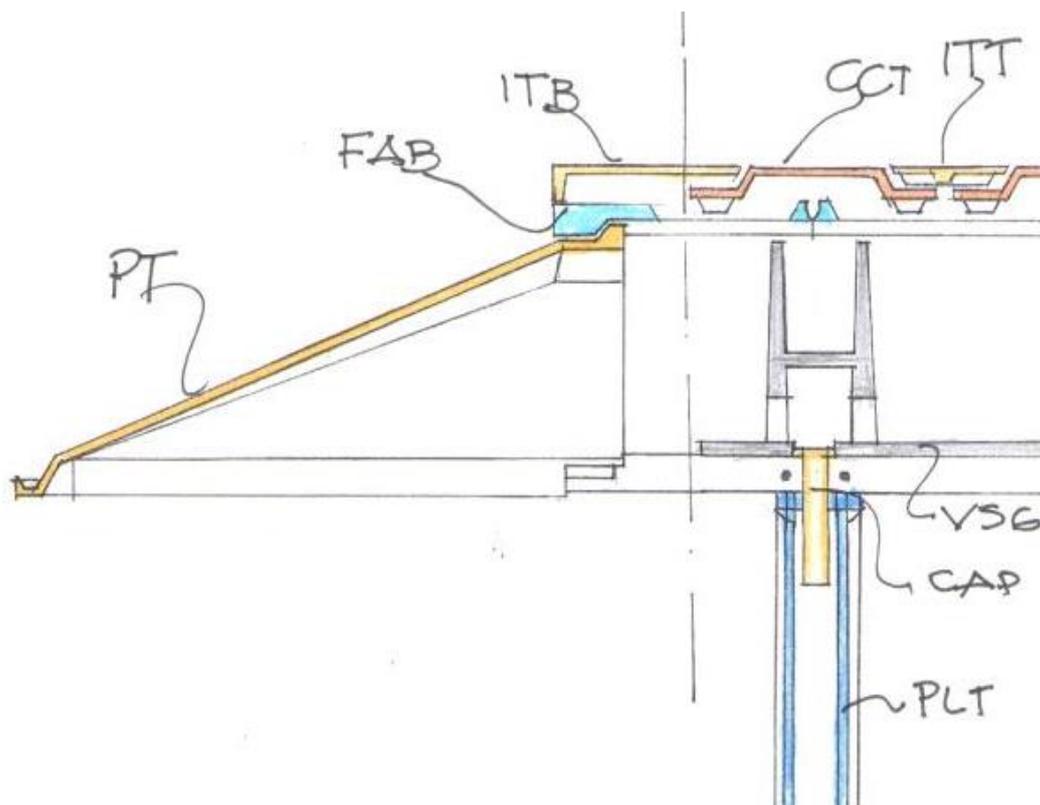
Detalhe lado externo módulo tipo. Fonte: Desenho do autor.
